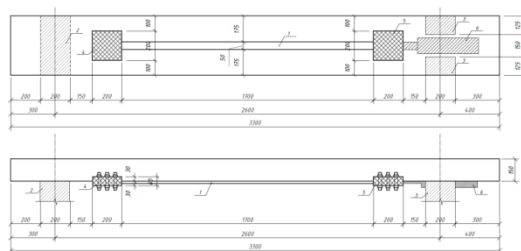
Схема усиления ж/б плиты, внешним ФАП-армированием с предварительным напряжением: 1 – ФАП; 2 – шарнирно-неподвижная опора типа 1 (сплошная); 3 – шарнирно-неподвижная опора типа 2; 4 – анкер типа 1 (клиновидный); 5 – анкер типа 2 (с упором); 6 – гидравлический домкрат.
